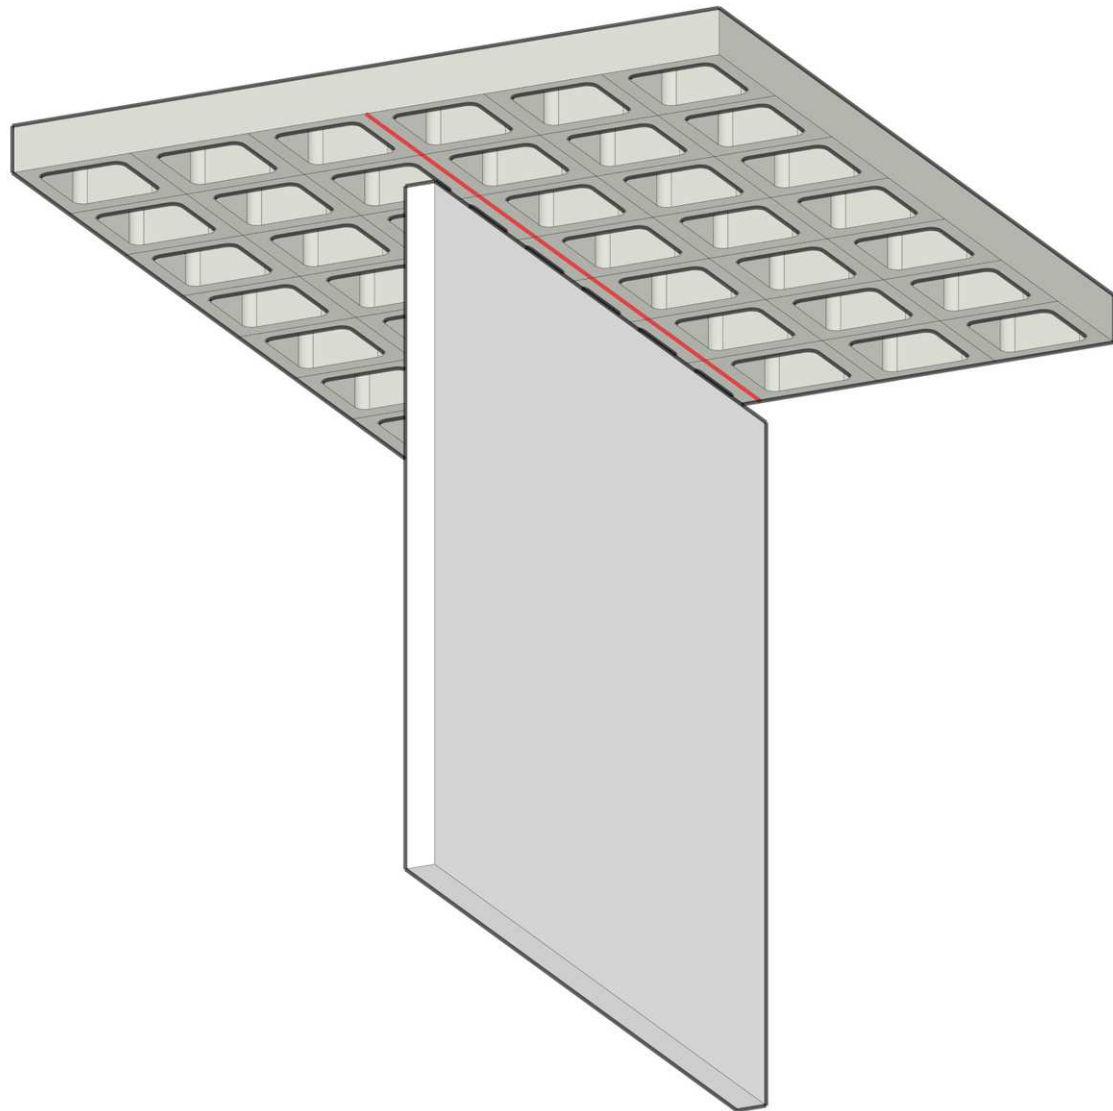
Sistema estrutural composto por laje nervurada e pilares. Fonte: Autor, 2018
